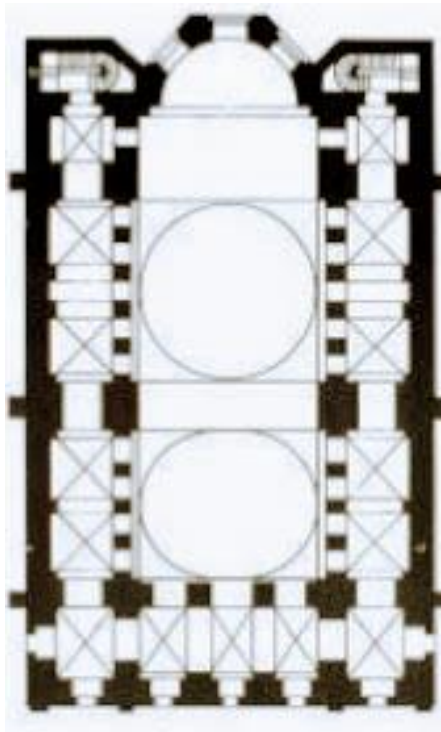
Planta de la basílica de Santa Irene tras la reforma del siglo VIII, Estambul.
